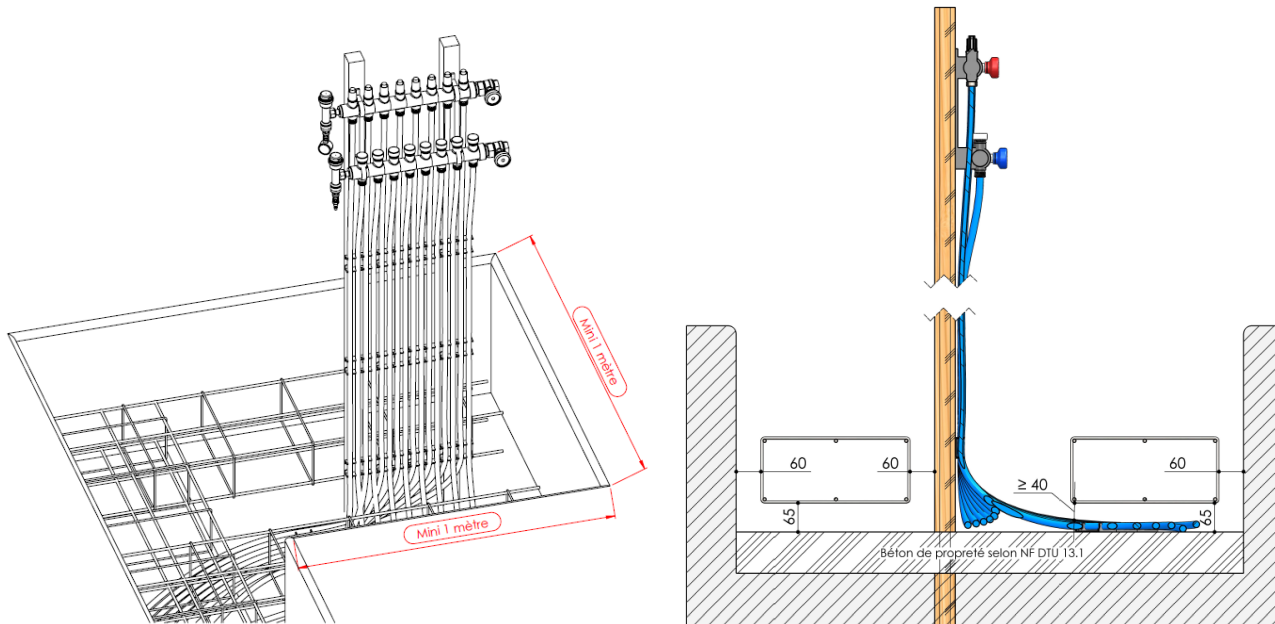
sortie des tubes en partie haute de semelle et réservation de dalle autour du collecteur - les armatures sont mises en œuvre continuité des semelles filantes et cette fois-ci de part et d'autre du procédé en assurant l'enrobage minimum des armatures en inférieur et en latéral.
